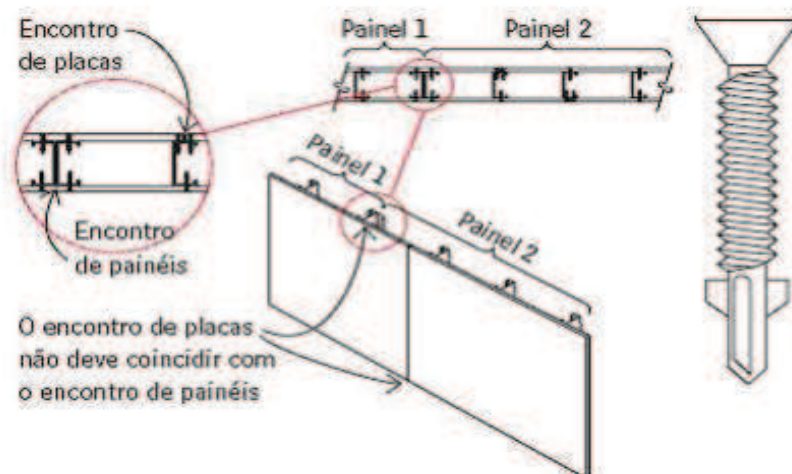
Detalhe da fixação de placas cimentícias em painéis de aço galvanizado.
